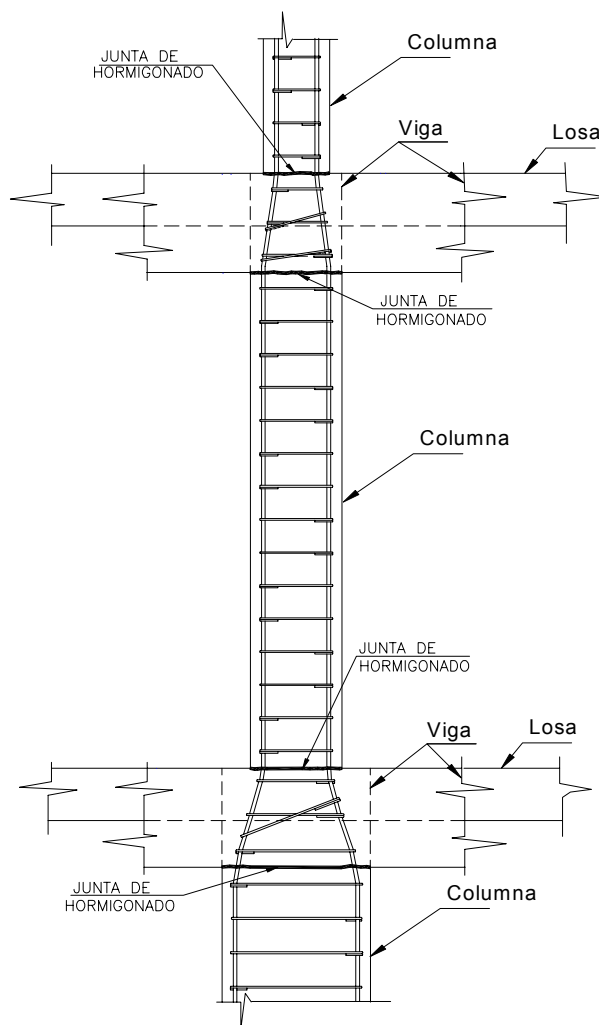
Ubicación de las juntas de hormigonado entre vigas, losas y columnas.
